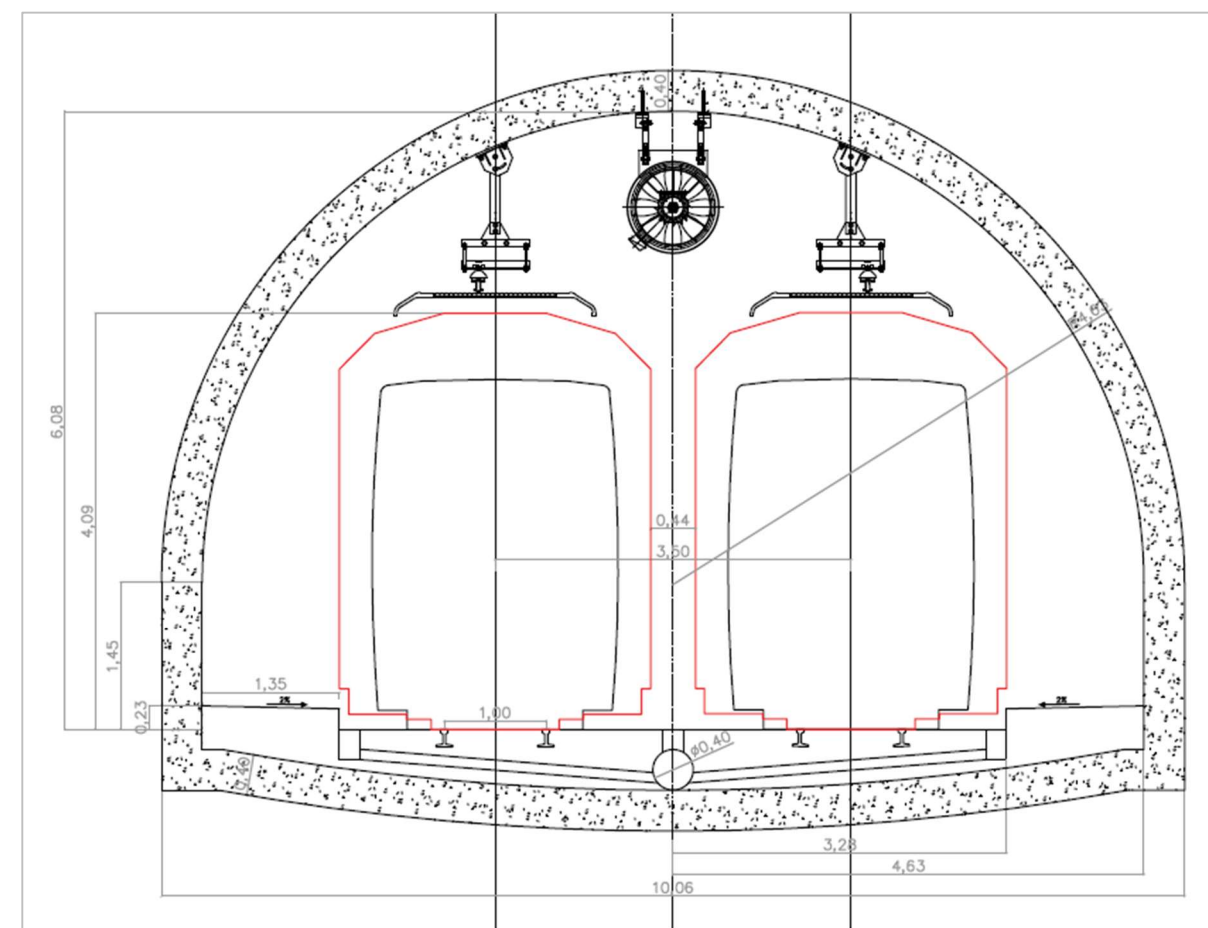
Sección transversal – Alternativa 1. (Fuente: Elaboración propia)
